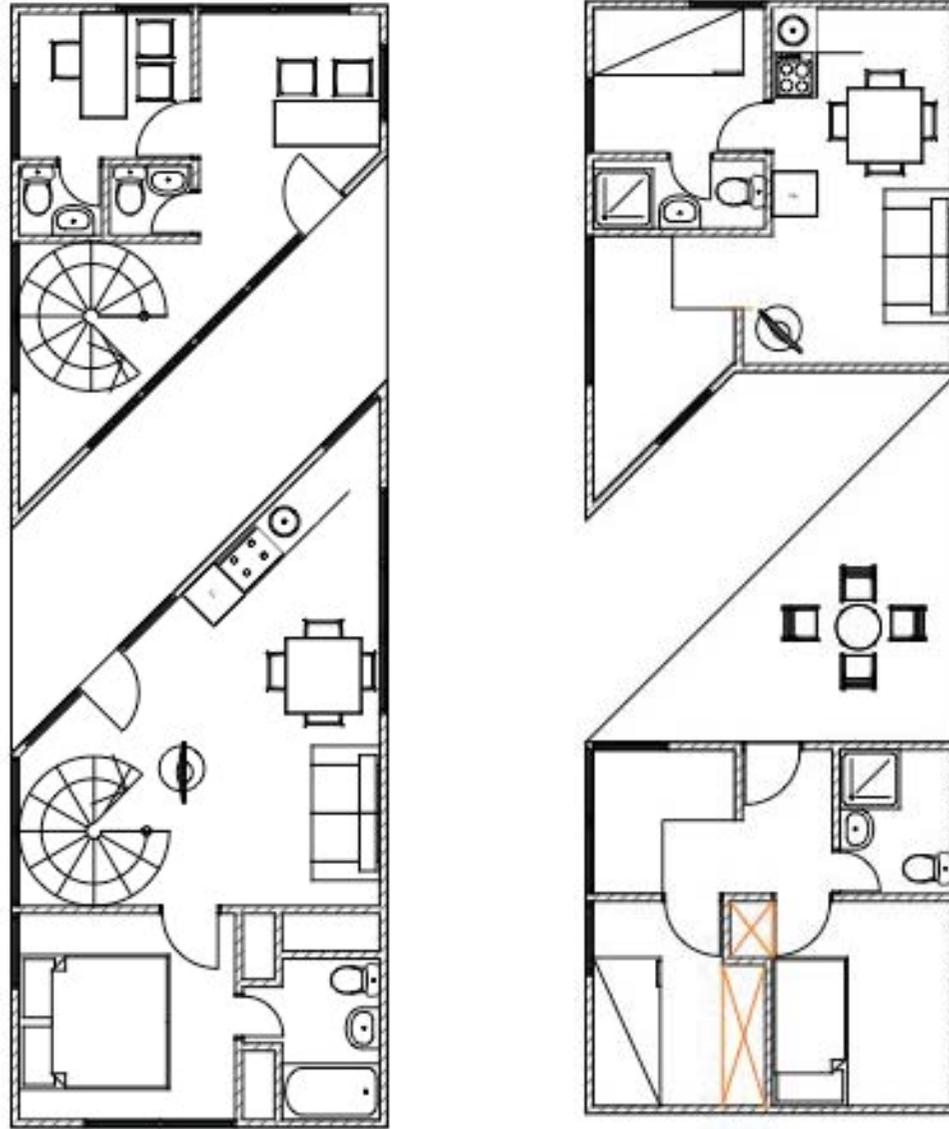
Planta Arquitectura Modelo Dos. Fuente: Miguel Oviedo.
